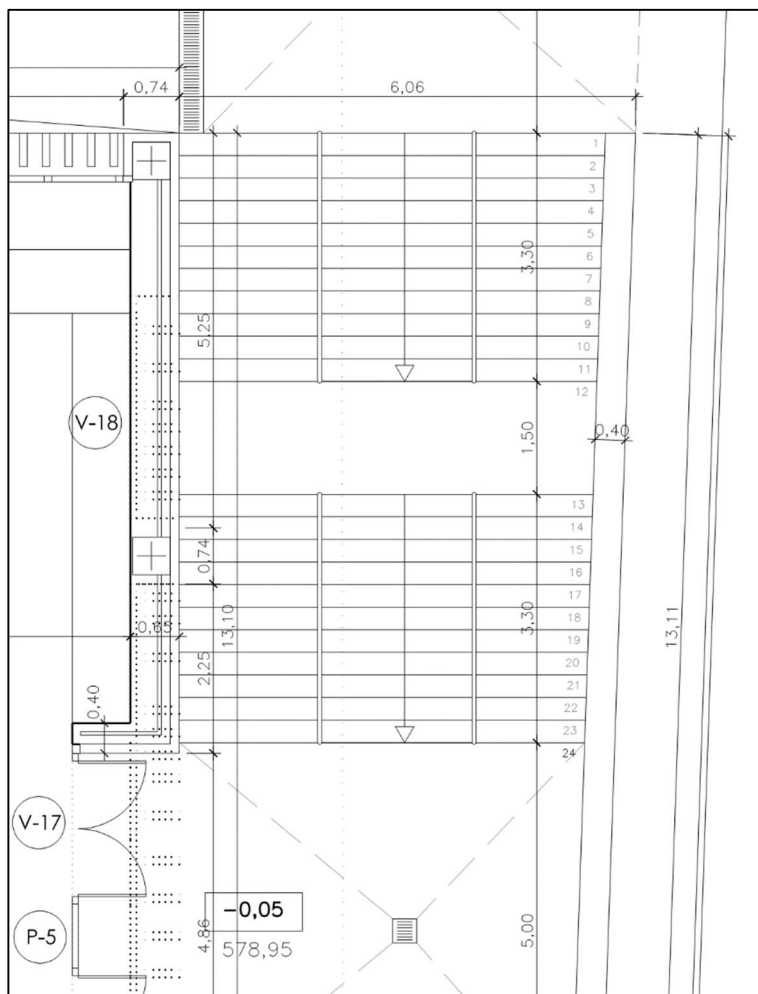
Escalera Exterior 1. Planos de Replanteo
